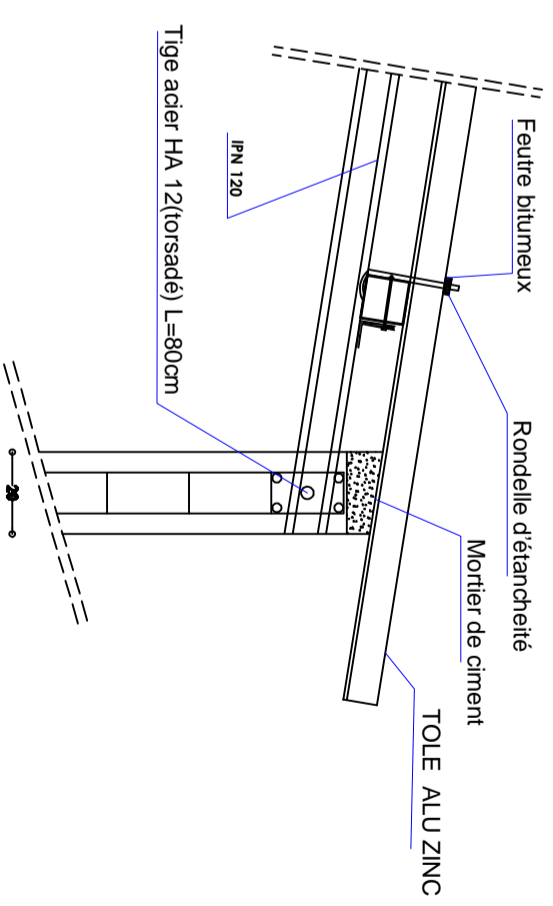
DETAIL DE FIXATION DE IPN120 SUR CHAINAGE
